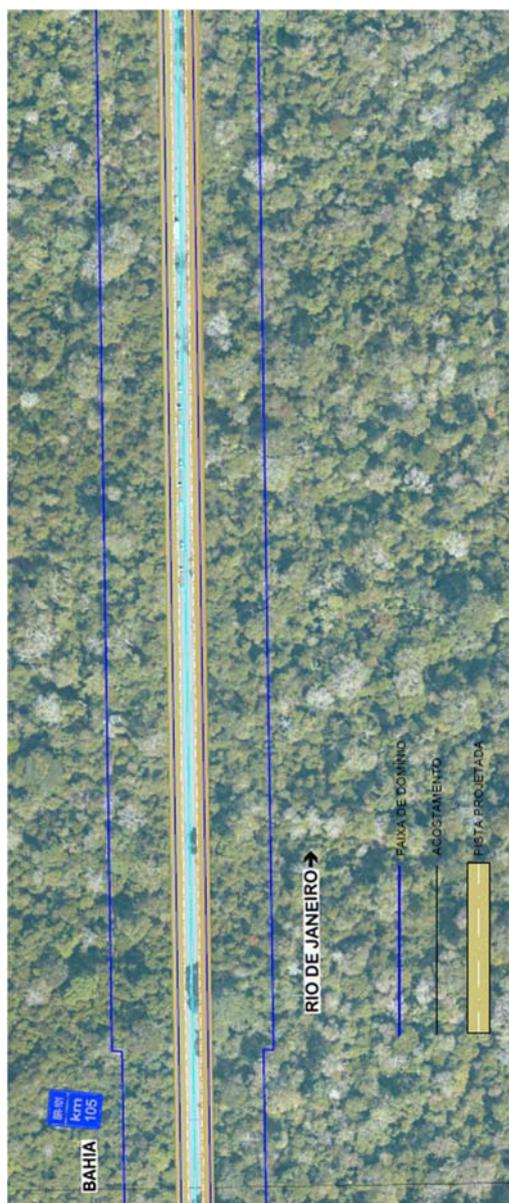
Duplicação do eixo central da rodovia existente
